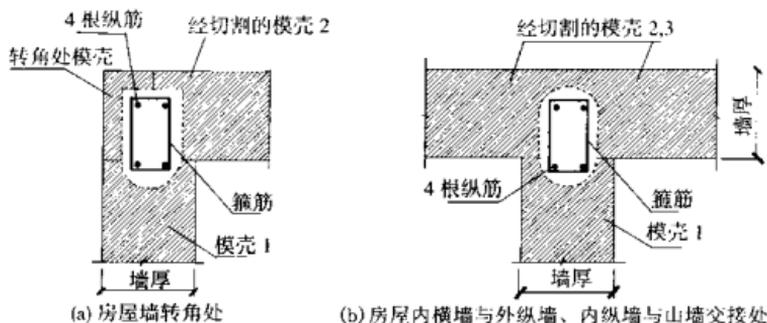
房屋墙体连接处构造边缘构件的配筋
